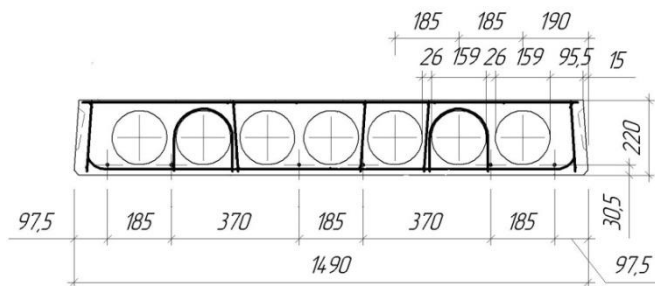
Конструкция пустотной плиты перекрытия
